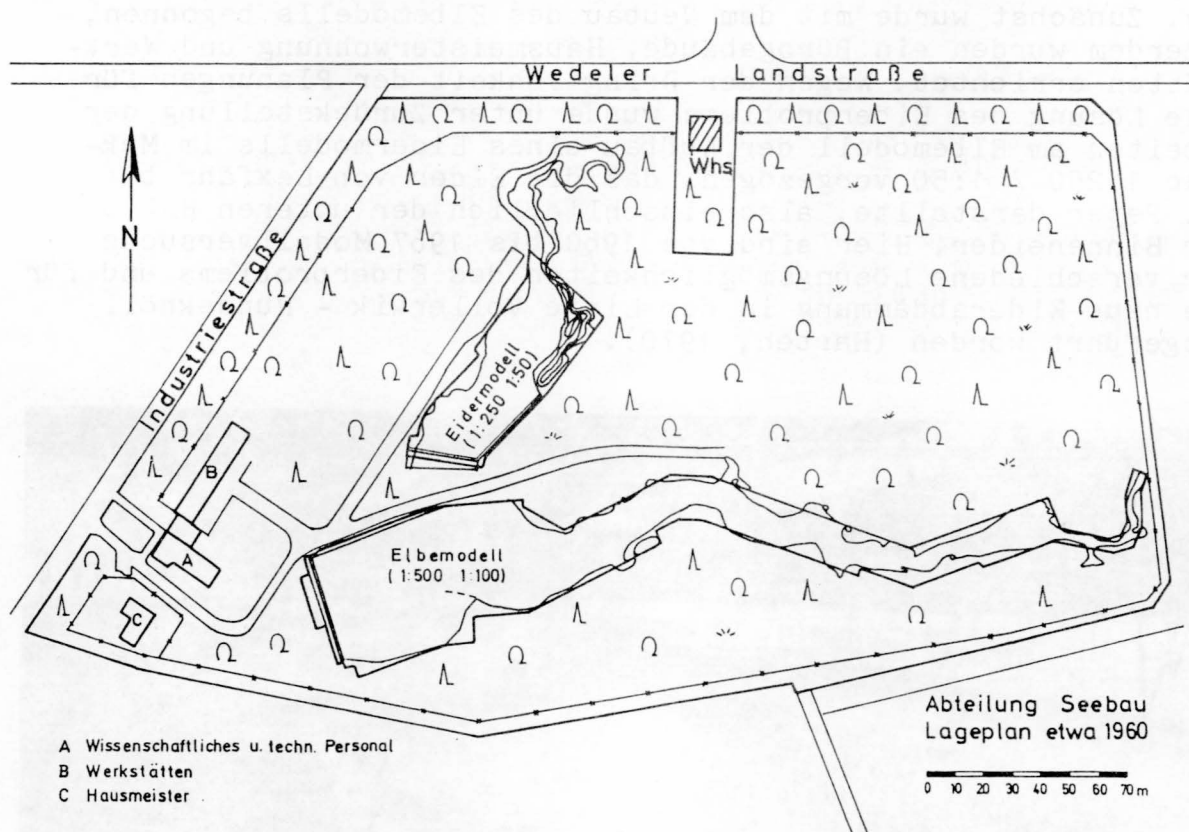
Lageplan des Geländes der "Abteilung Seebau" in Hamburg-Rissen
